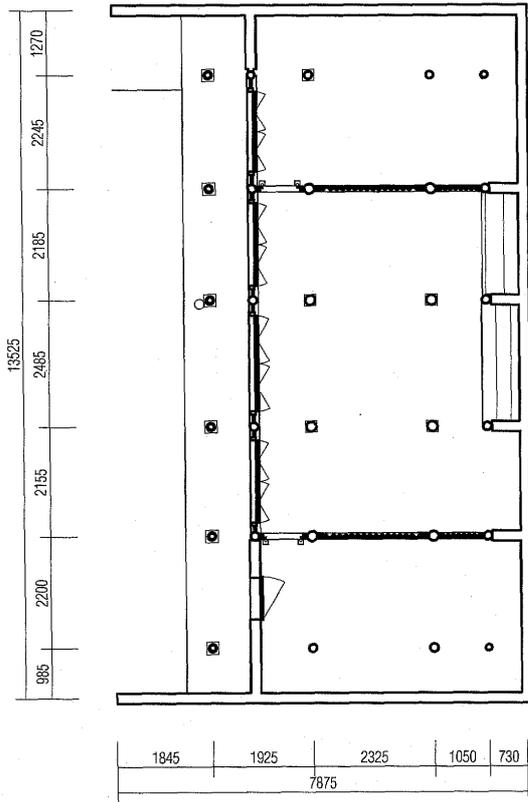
Nguyen Van Hang邸 主屋 平面図
